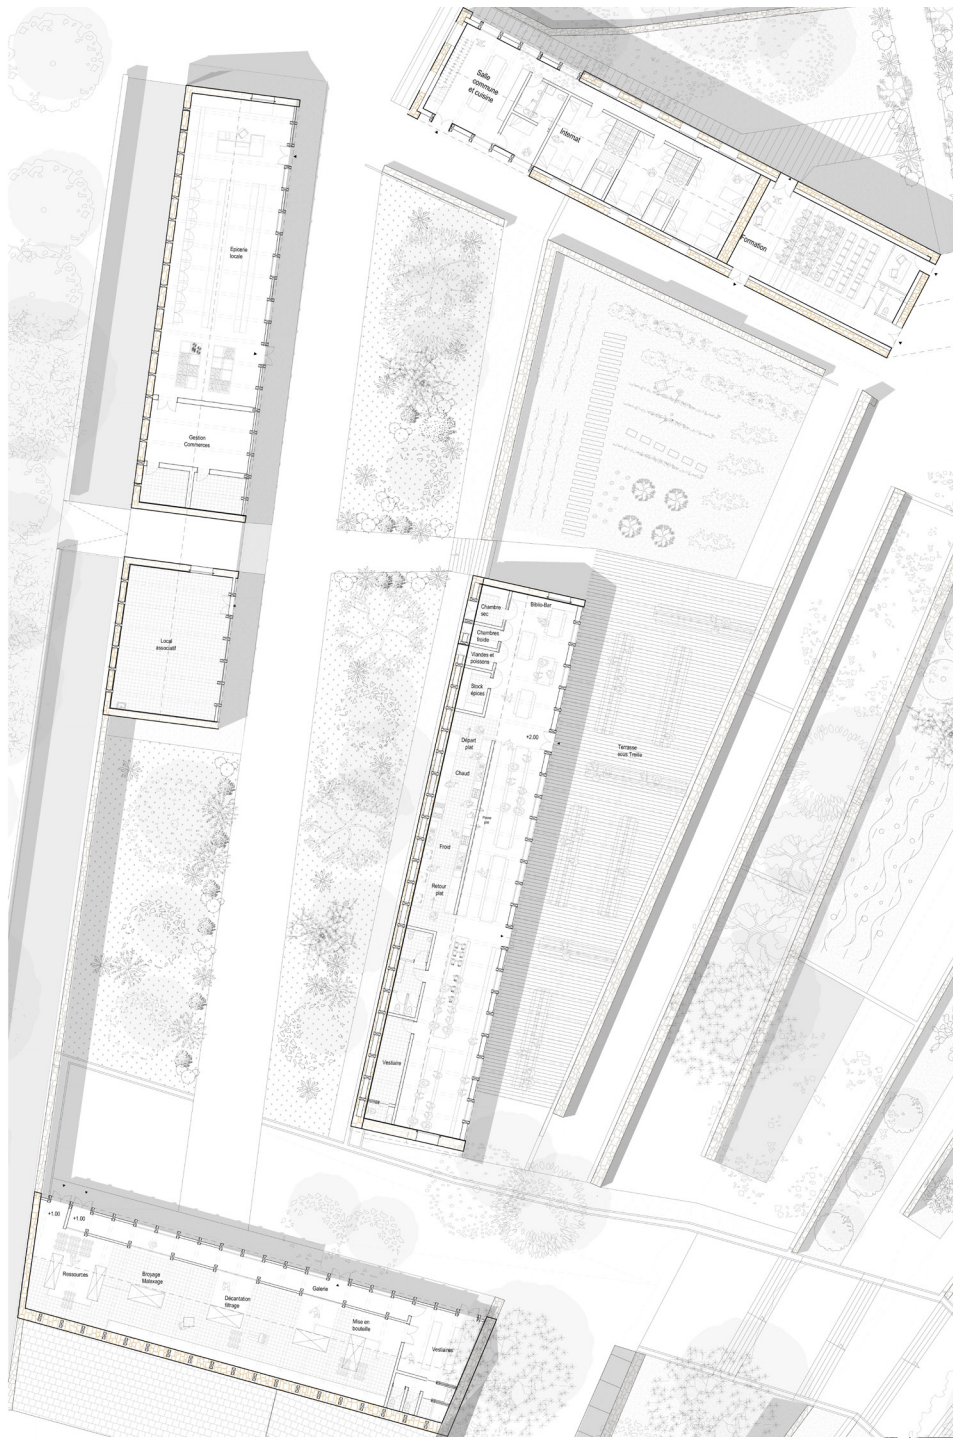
Différentes unités fonctionnelles // plan de rez-de-chaussée
